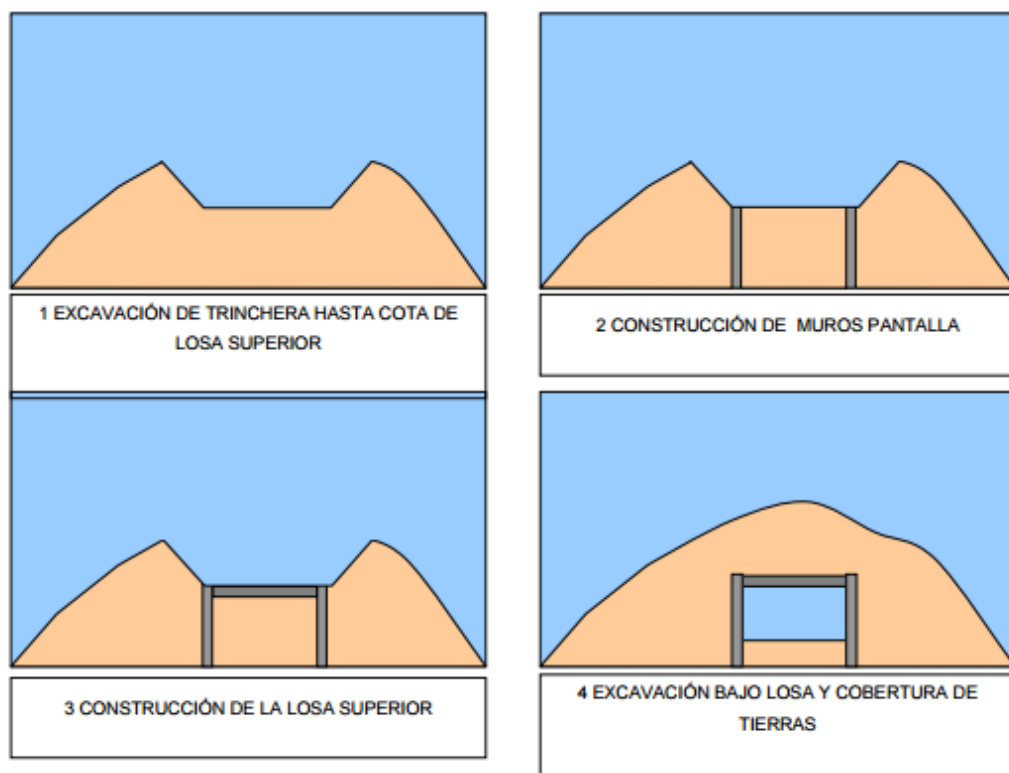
Esquema constructivo de falso túnel entre pantallas. (Fuente: Anejo N.º 6 Estructuras y Túneles del Estudio informativo de la línea ferroviaria Valencia – Alicante (tren de la costa)).
